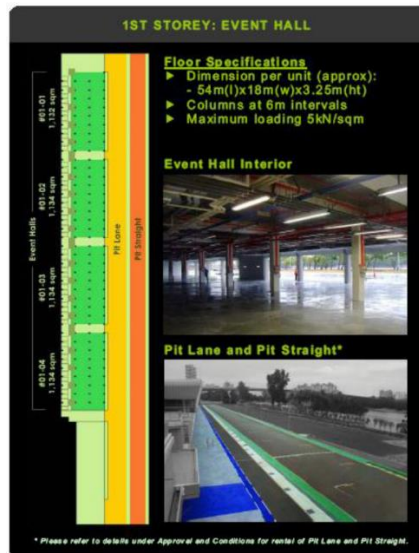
29 Lokasi Pit Building Singapura (Sumber :
